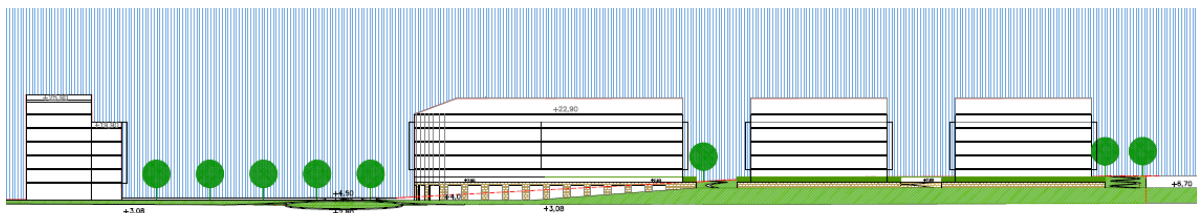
Sección y perfil de las edificaciones propuestas por el PEOU, imagen de la fachada norte de las edificaciones. Fuente: Memoria del PEOU del ámbito “8.3.04 / Lastaola-Postetxea” del PGOU de Irún.
